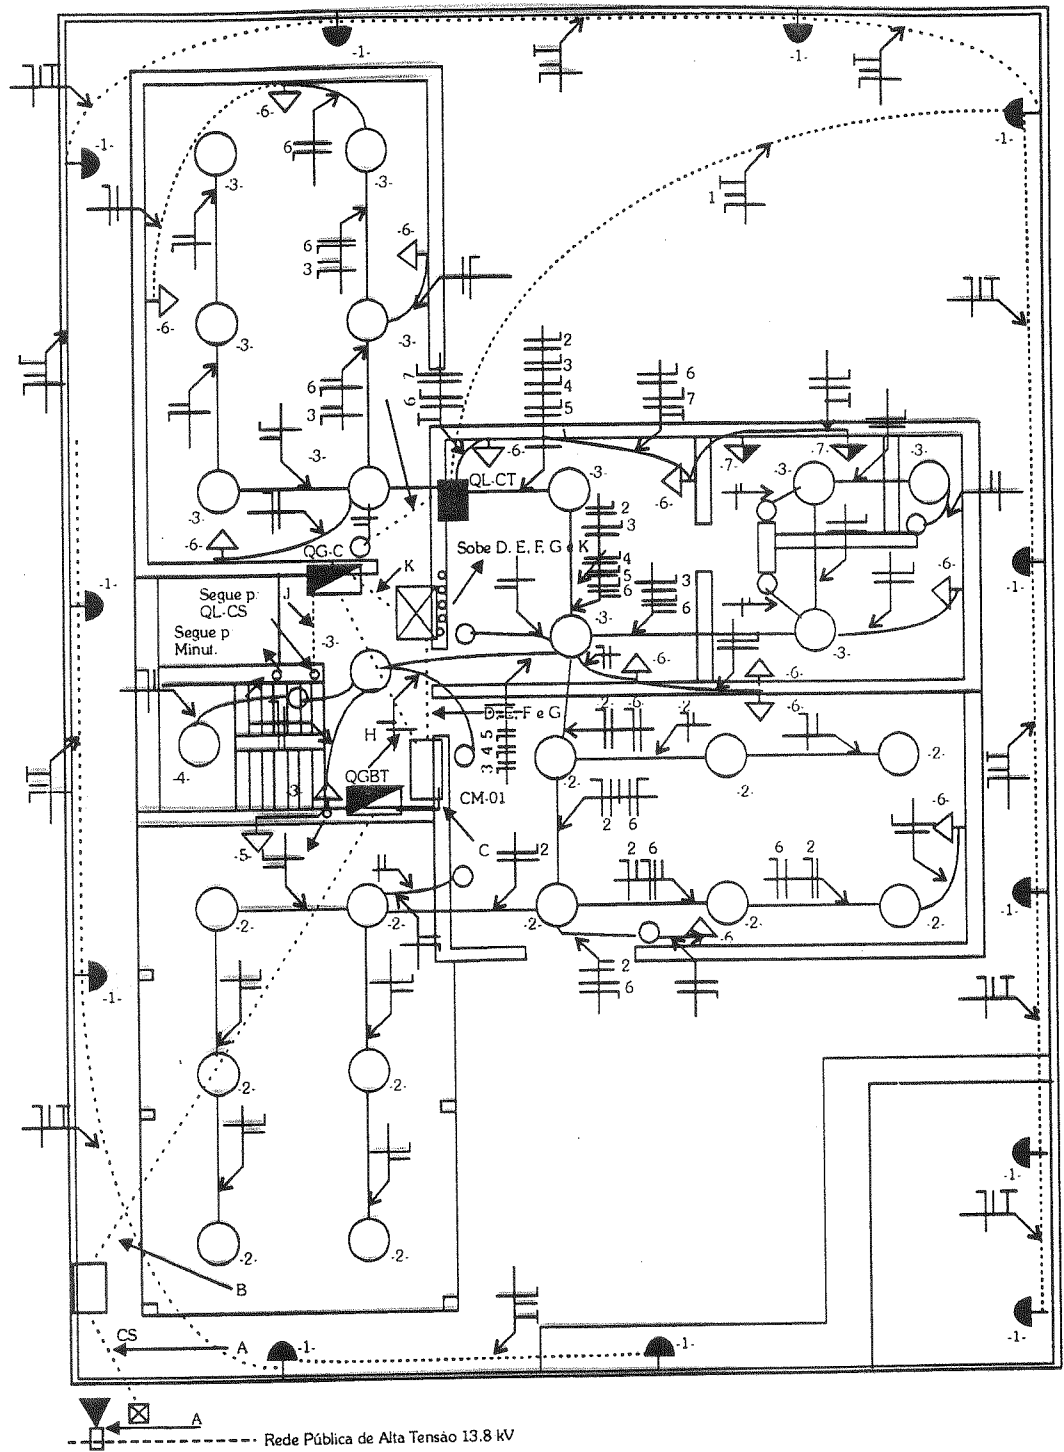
Edifício de Apartamentos - Instalação Elétrica do Pavimento Térreo
